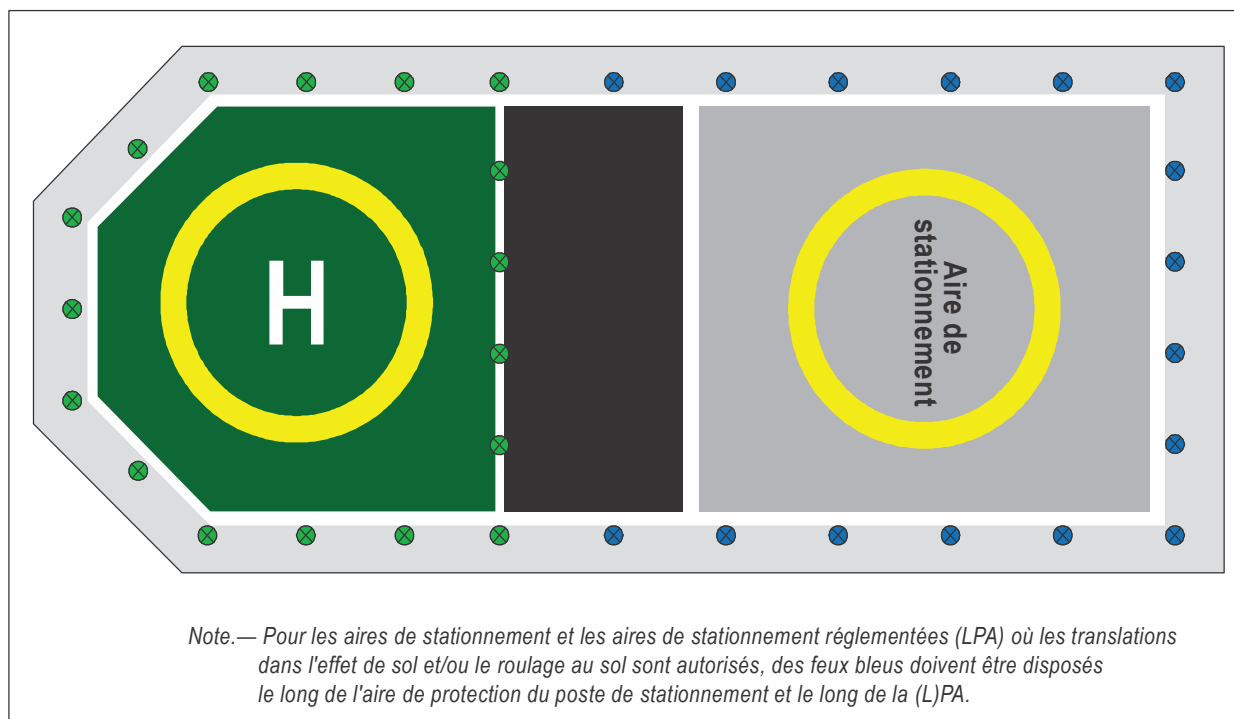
Dispositif d'éclairage de pont pour l'aire d'atterrissage et l'aire de stationnement
